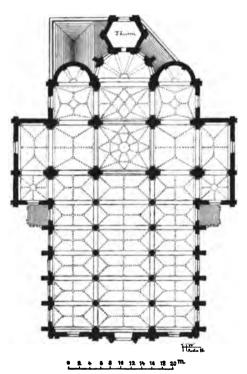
Beguinenkirche zu Brüffel, Grundriss.
